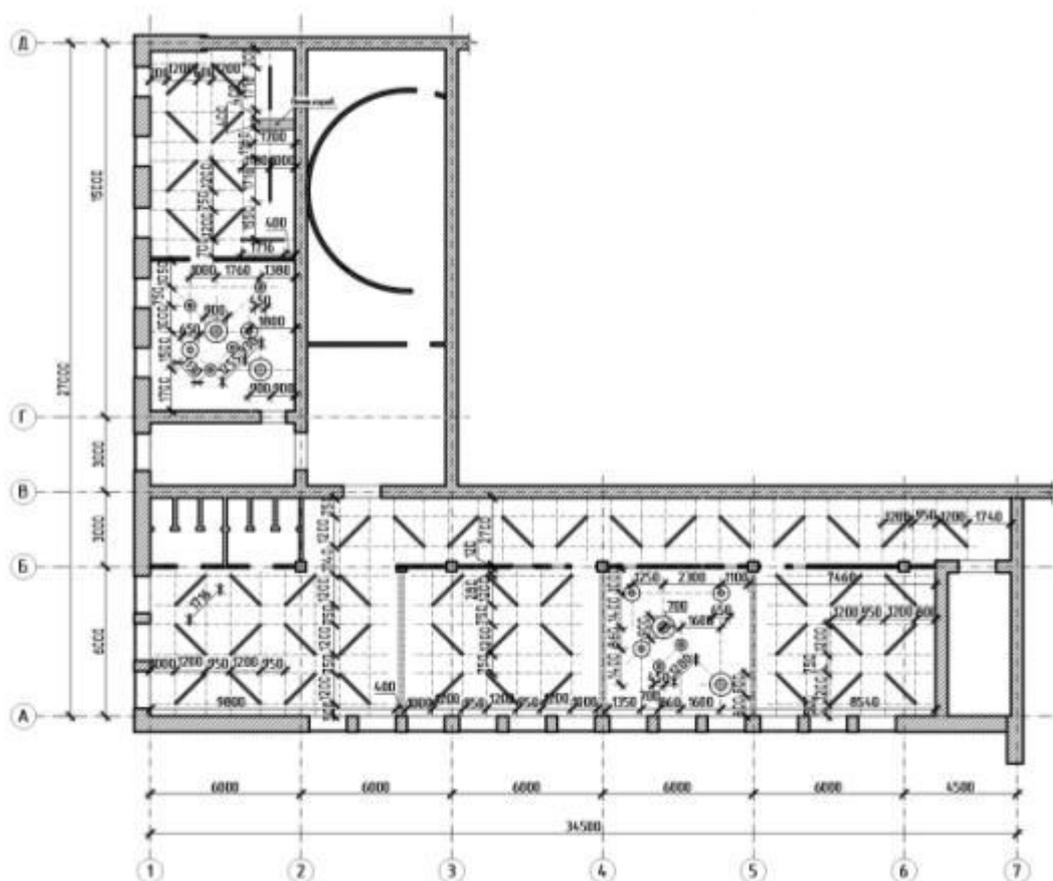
План потолка учебных залов. 3 этаж
